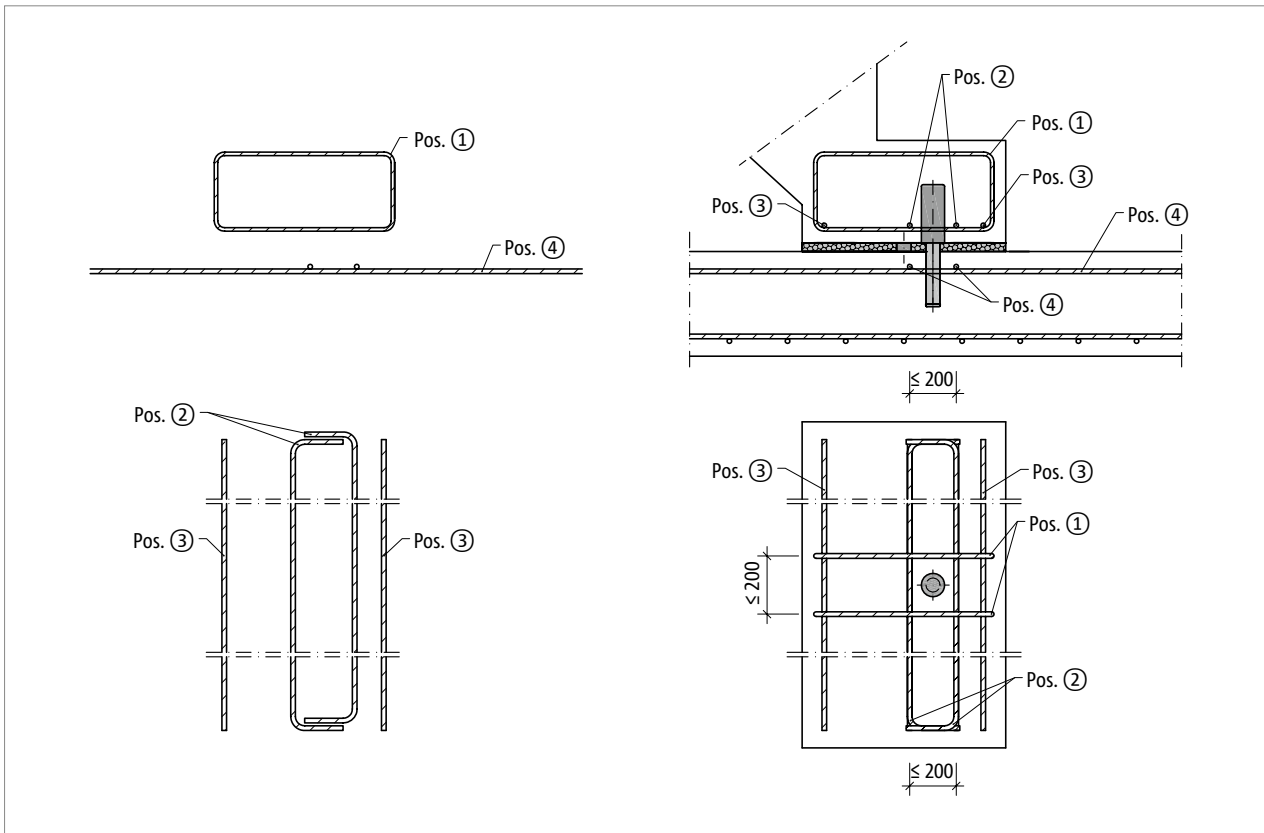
Schöck Tronsole® Typ D: Bauseitige Bewehrung
